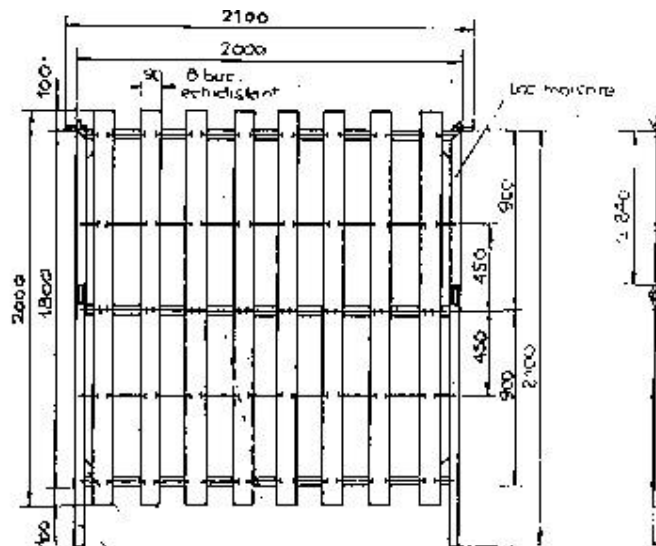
Panou mobil de parazăpezi din metal pe cadru din cornier.
